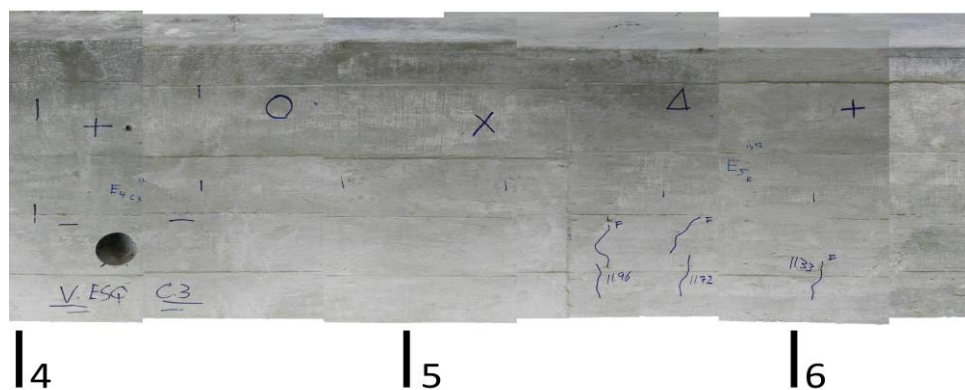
Foto da viga esquerda entre os 4 e 6,5 metros
